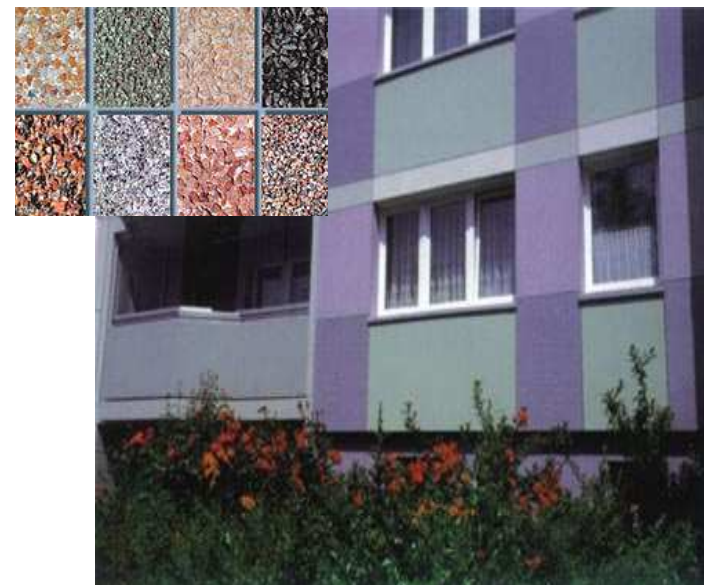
Фасады, облицованные цементно-волоконными плитами
